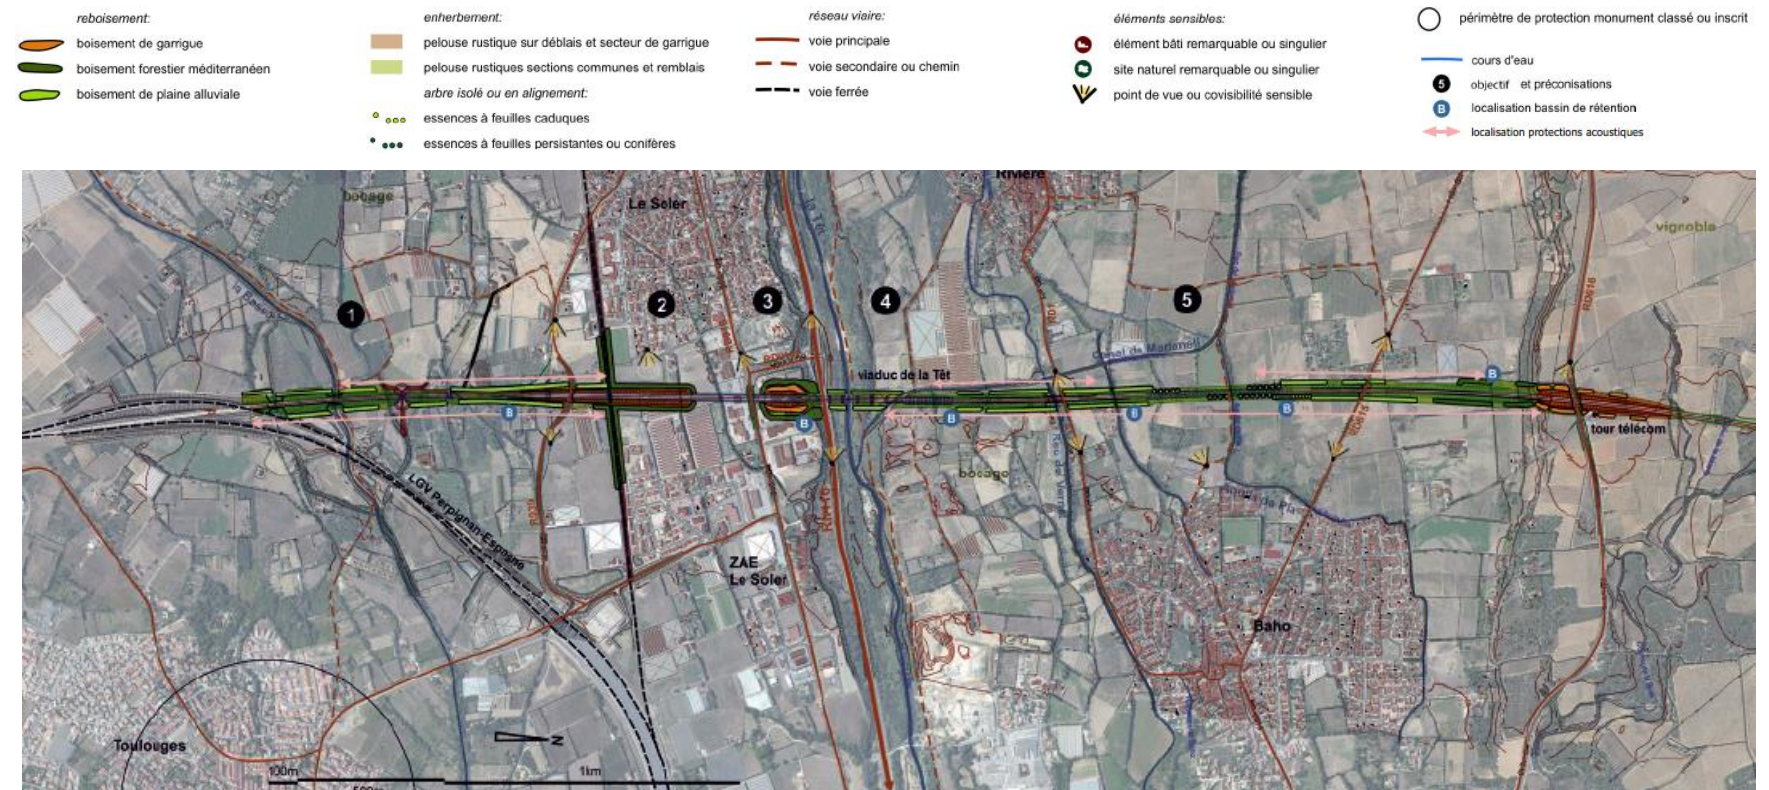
plan des mesures paysagères dans la traversée du Soler et de la vallée de la Têt (source : Traverses)
